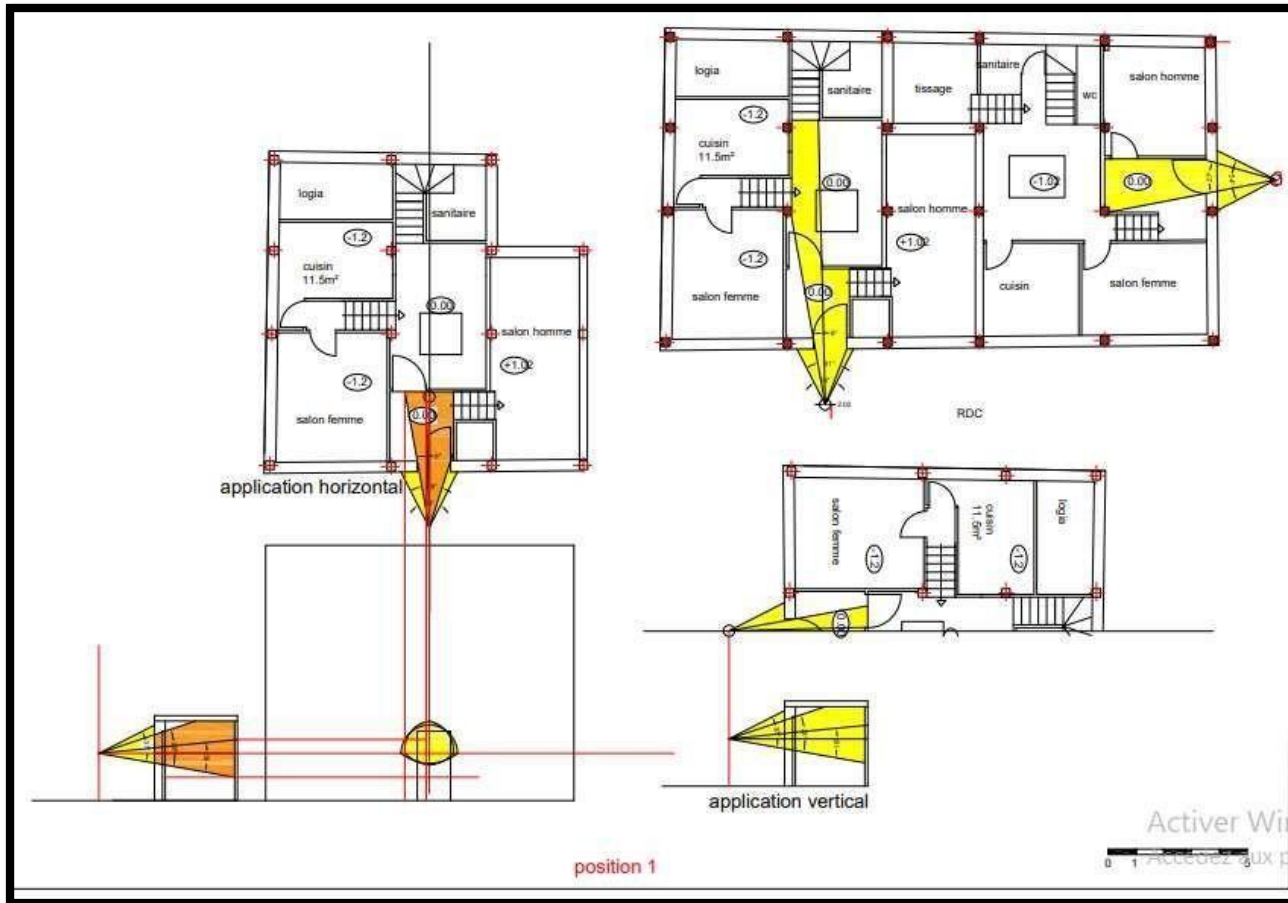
Position 01 , plan : Imbriqué verticalement type 01
